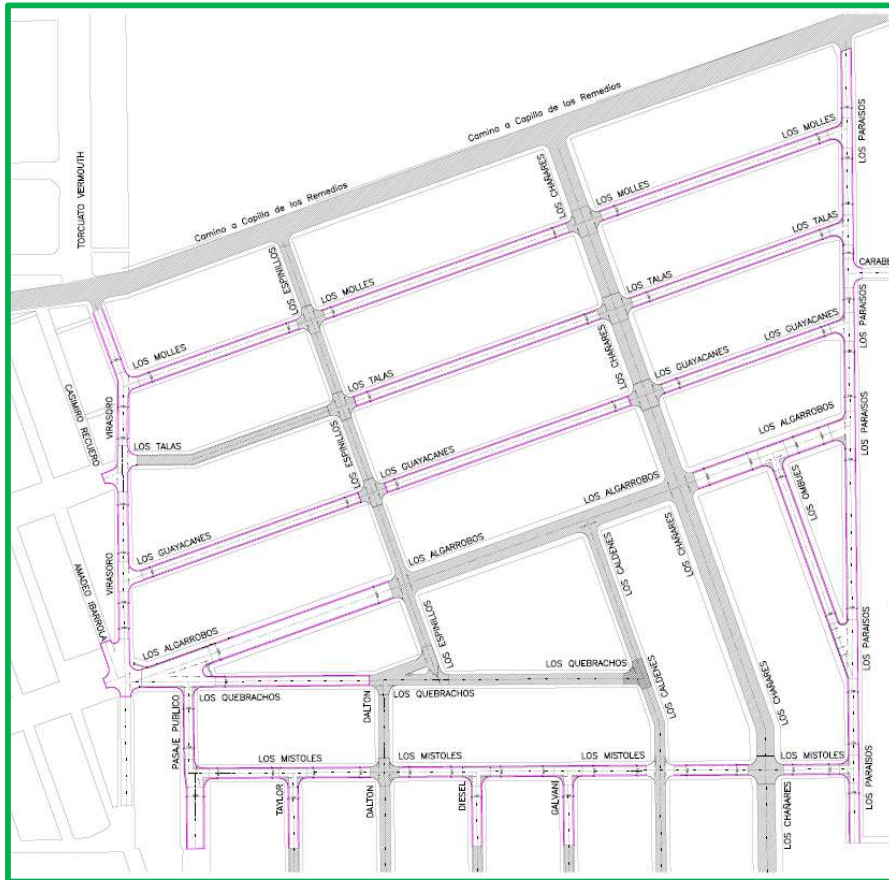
Planimetría del proyecto Los Sauces (Municipalidad de Córdoba)
